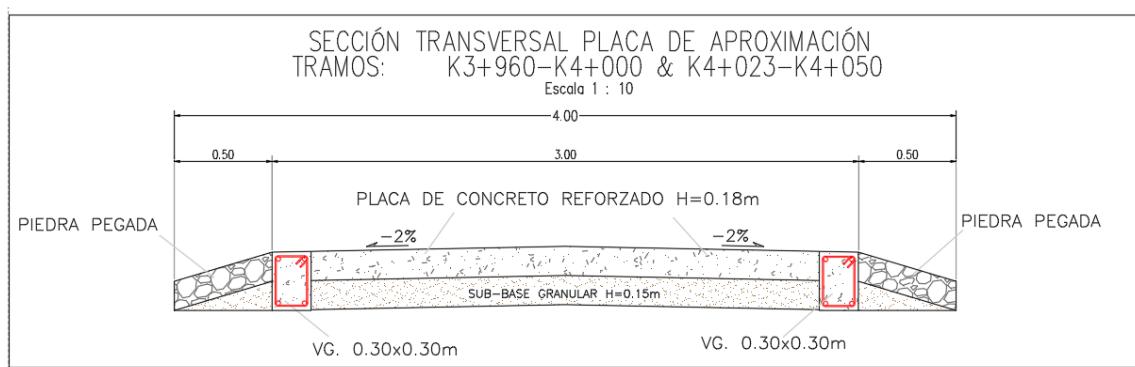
Perfil sección transversal de placas de aproximación al cauce del río Jerez.
